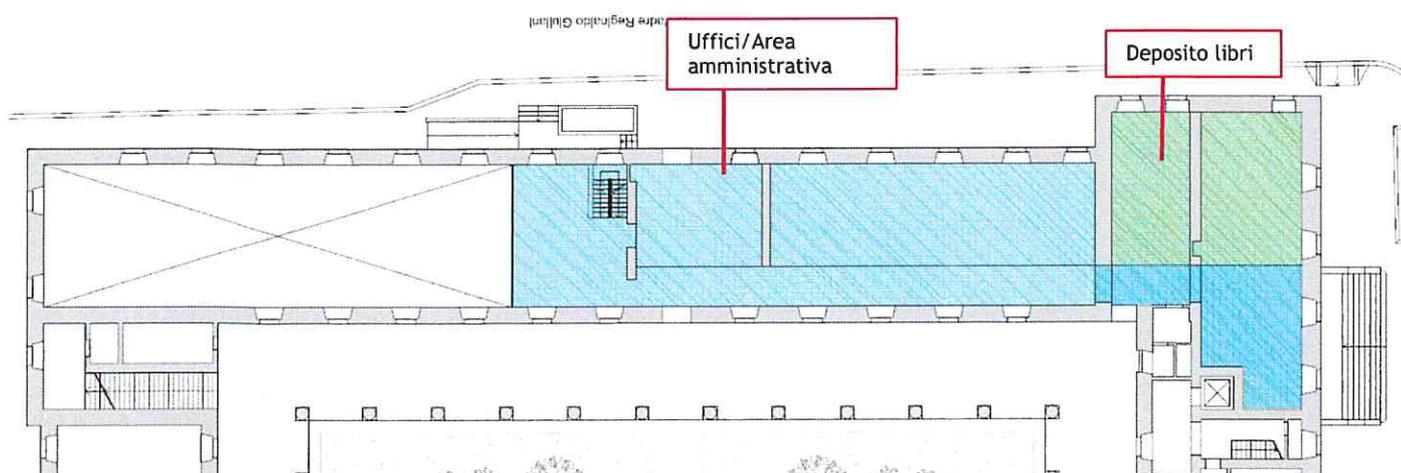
\_Planimetria Biblioteca Civica dello stato di fatto (piano primo)
